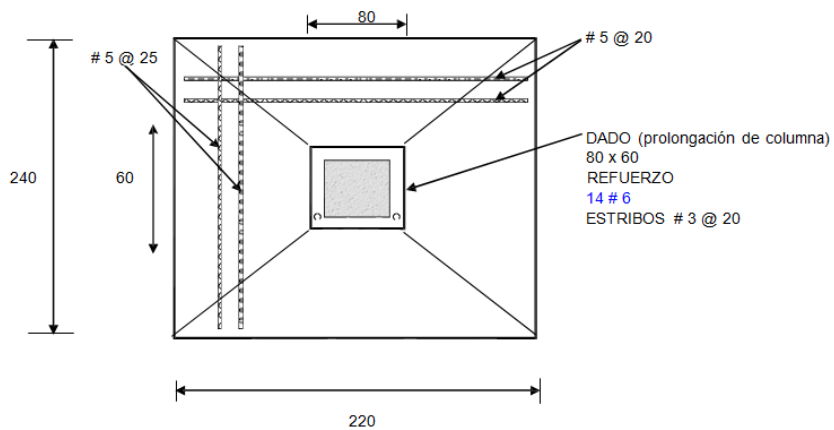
Dimensiones en planta de zapata Z-7.
